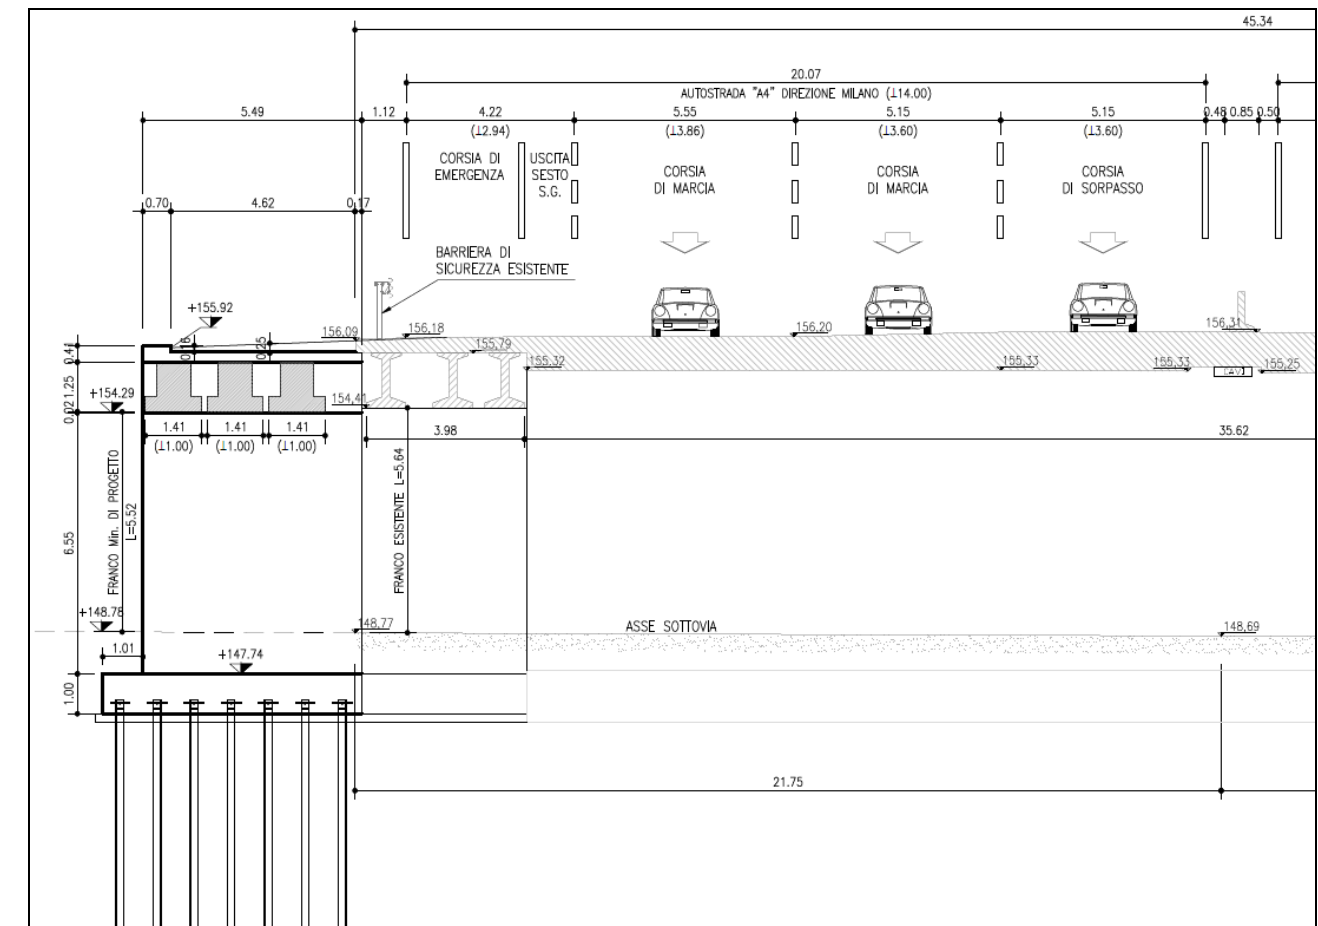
Sezione longitudinale lato Bergamo – OP2
